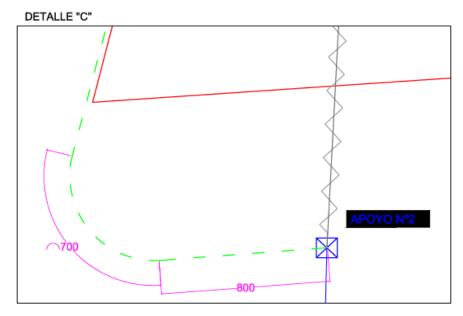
Plano de planta trabajos a realizar para instalación de enlace con Cía distribuidora, detalle hasta apoyo №2.
